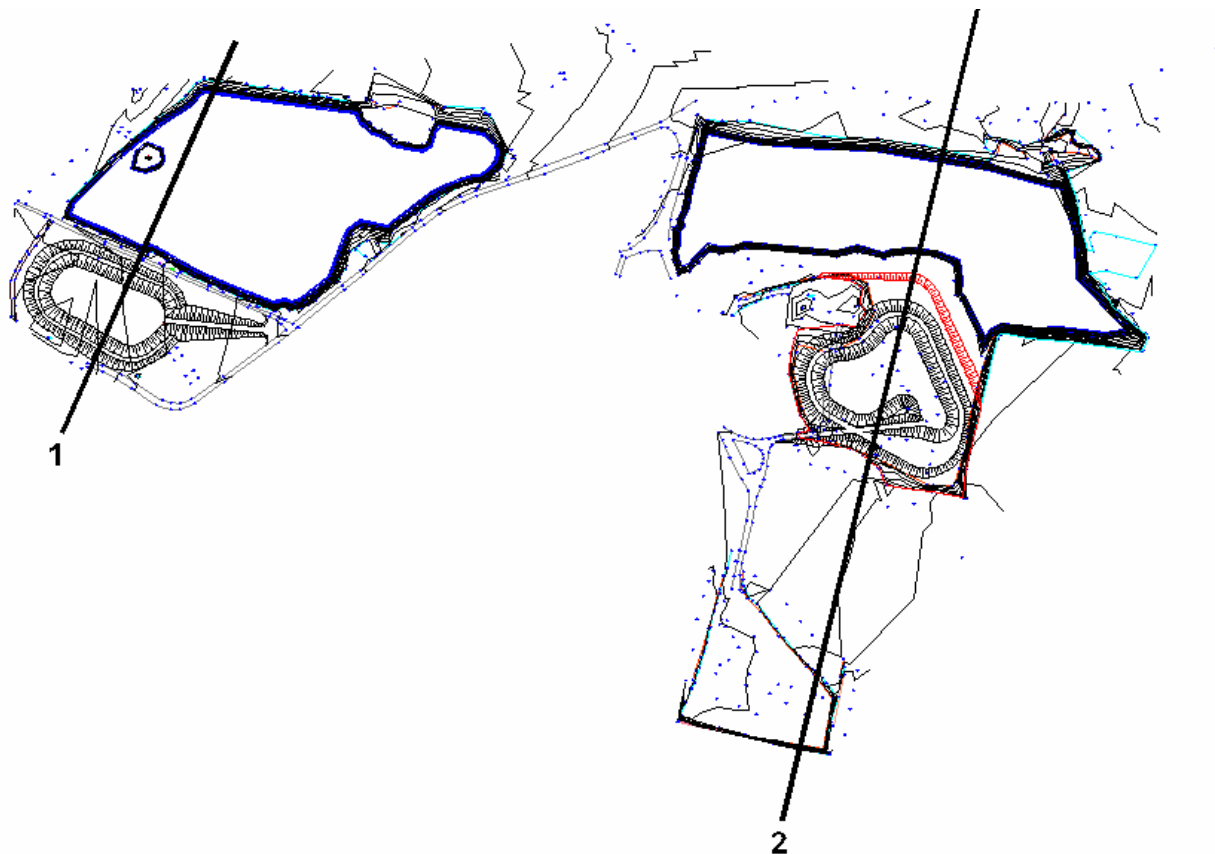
Planimetria del deposito con indicazione delle sezioni di calcolo
